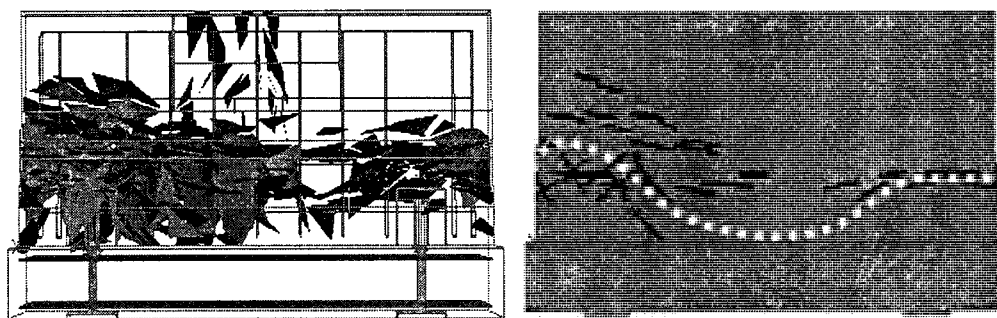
24: Fissuration du parapet en BHP 50MPa
